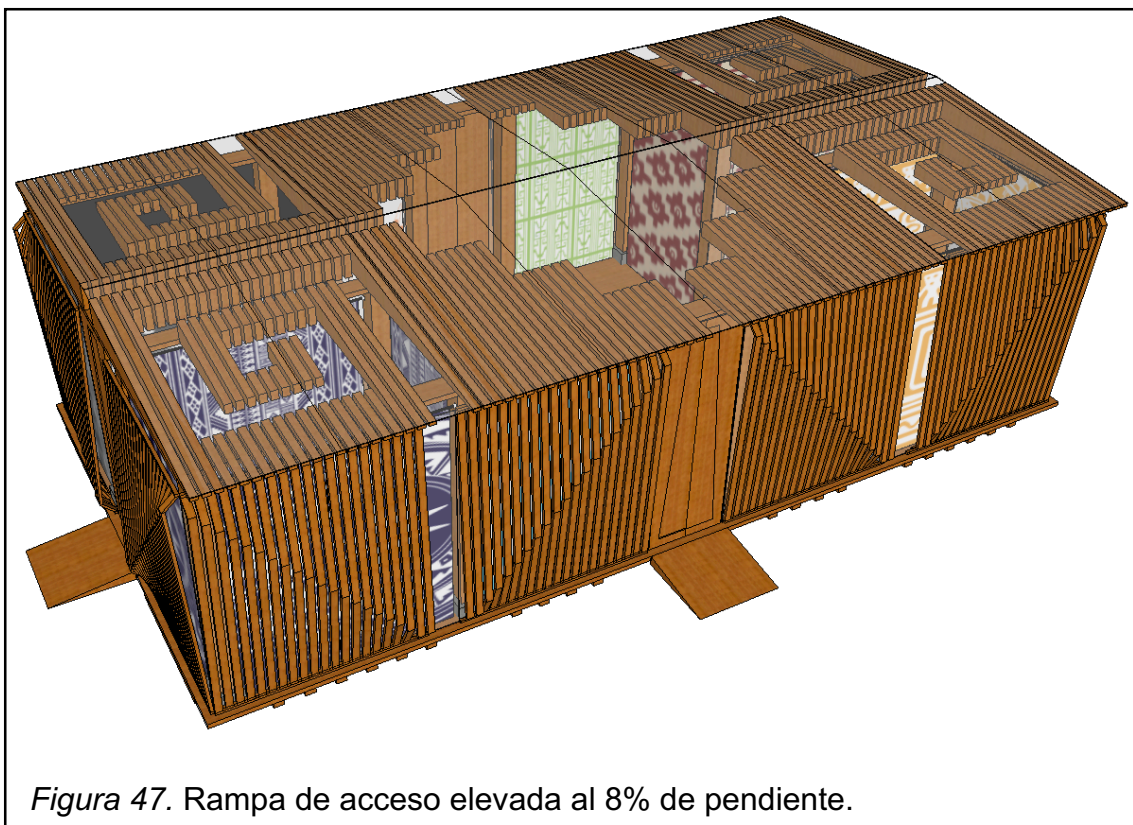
Rampa de acceso elevada al 8% de pendiente.
